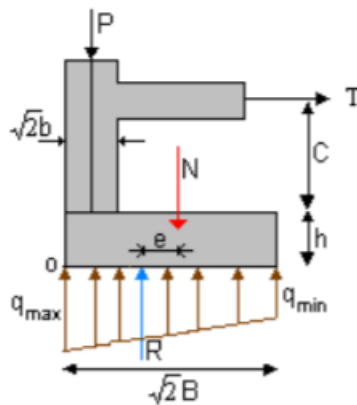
Modelo estructural de la Zapata Esquinera con Distribución Variable de Presiones y Dos vigas Aéreas
